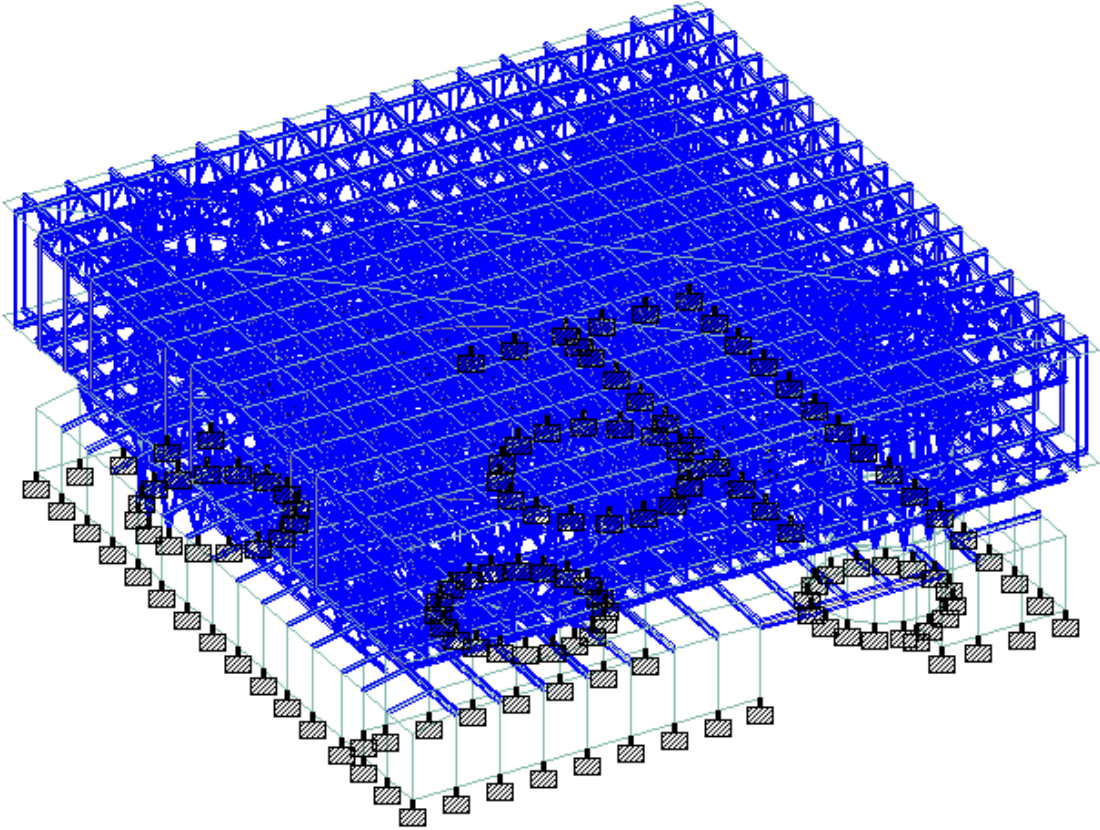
Fig. V.d DISTRIBUCION GENERAL DE ARMADURAS
